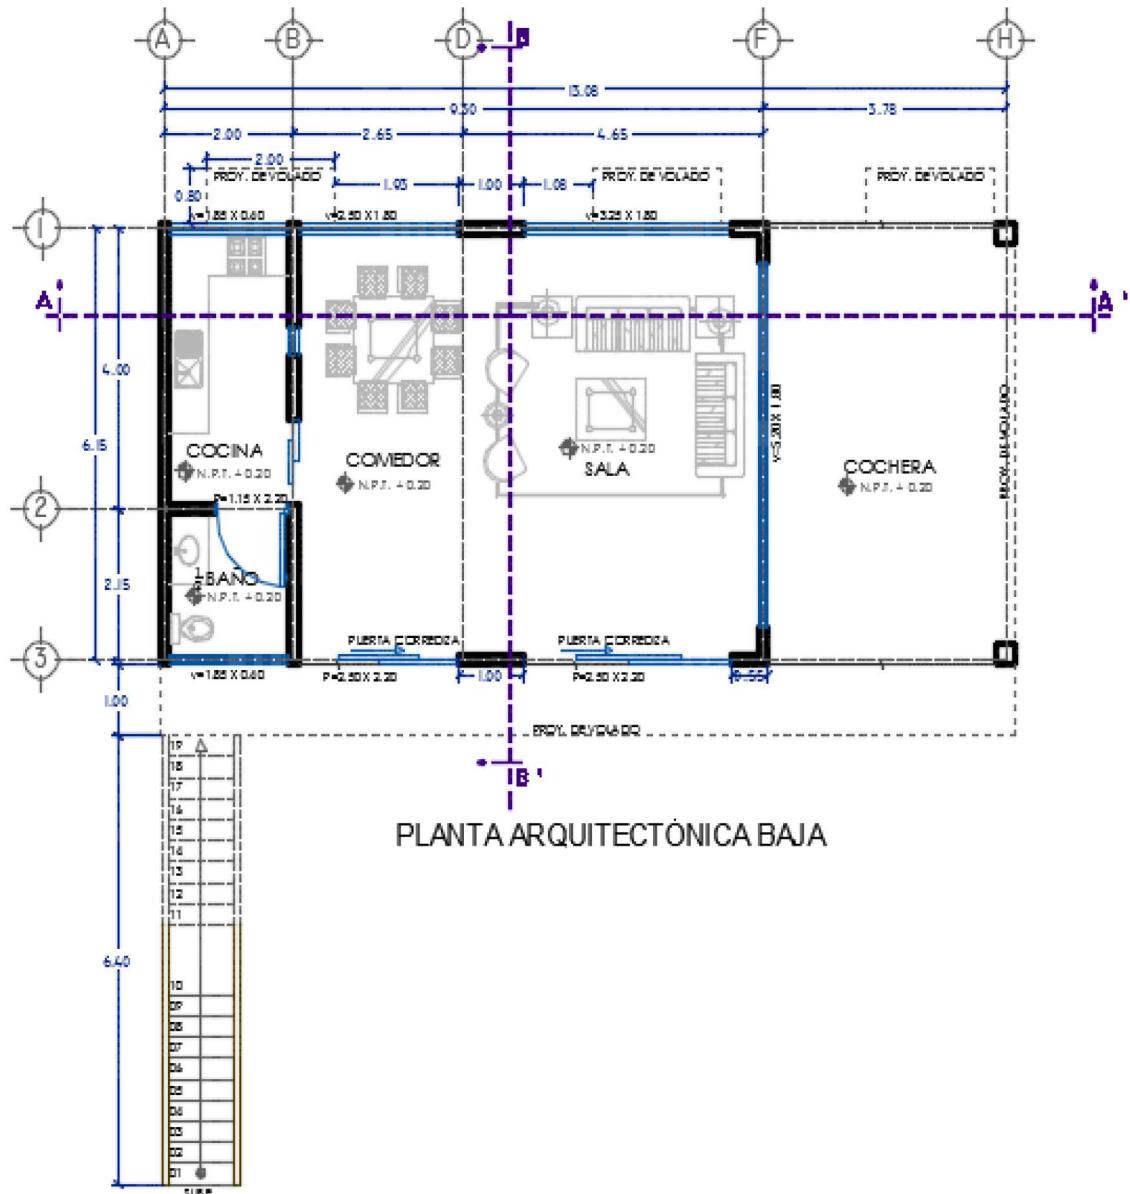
Planta baja. Casa de Veraneo (Retiros).
